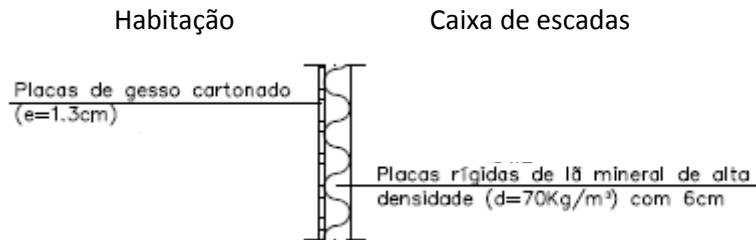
Pormenor construtivo da parede Pi7 [17]
